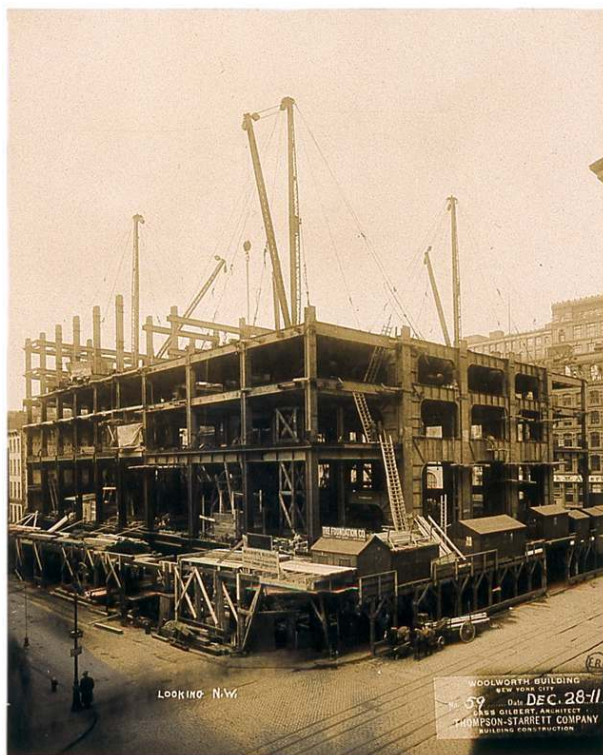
Anon., montage de l'ossature du Woolworth Building à New York (détail d'une planche d'album), Etats-Unis, tirage argentique, 64,8 x 95,6 cm, 8 novembre-28 décembre 1911, coll. ENSBA.
